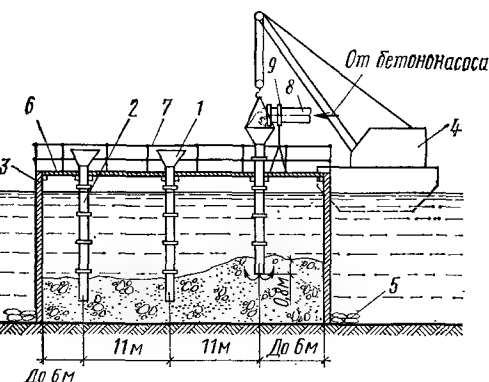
Подводное бетонирование методом вертикально перемещающихся труб (ВПТ):
